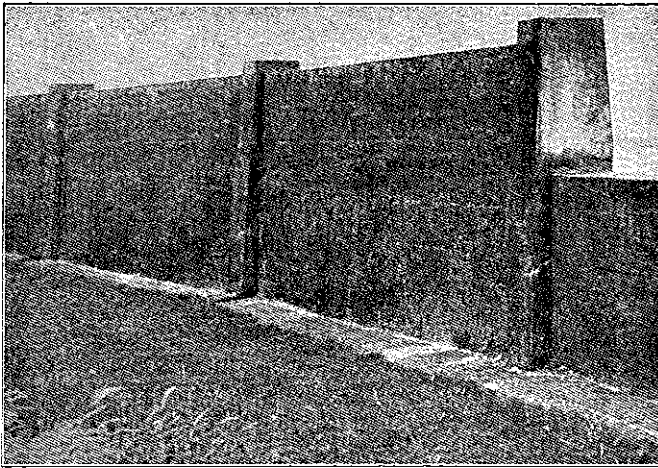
Bestaande betondijksverhooging later 40 c.M met beton verhoogd (Zuid-Beveland)
